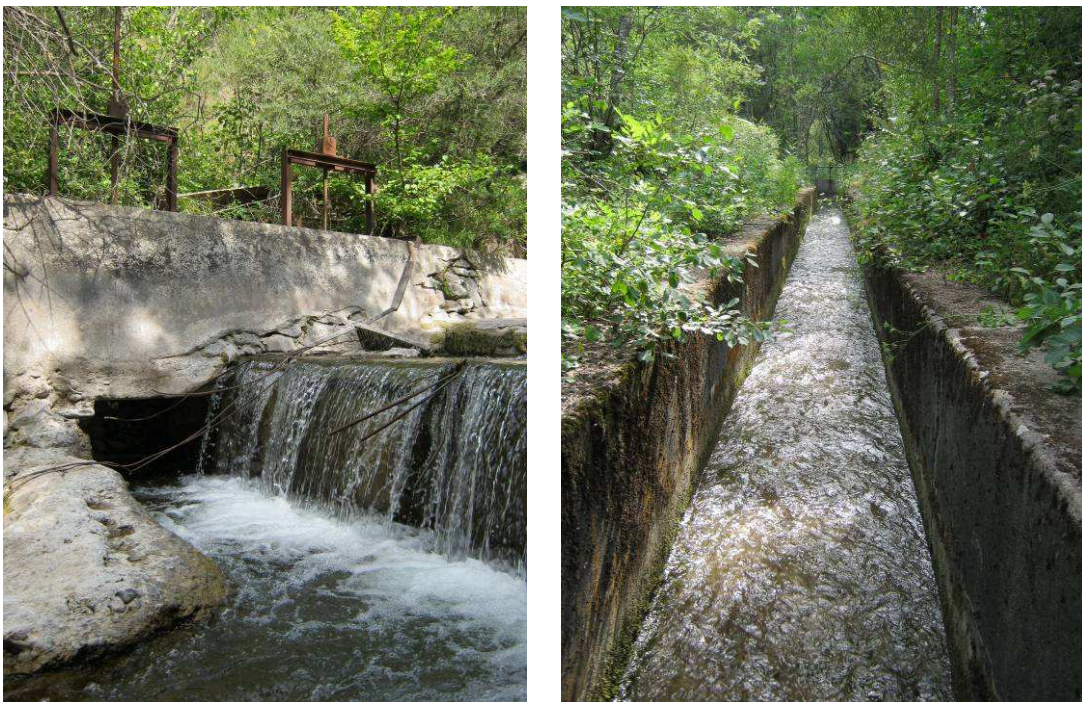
Prise d'eau et canal maître – Torrent d'Anelle
